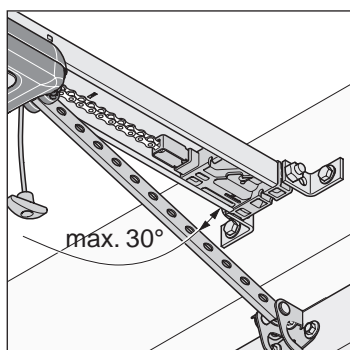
Najwyższy punkt przesuwu bramy segmentowej
